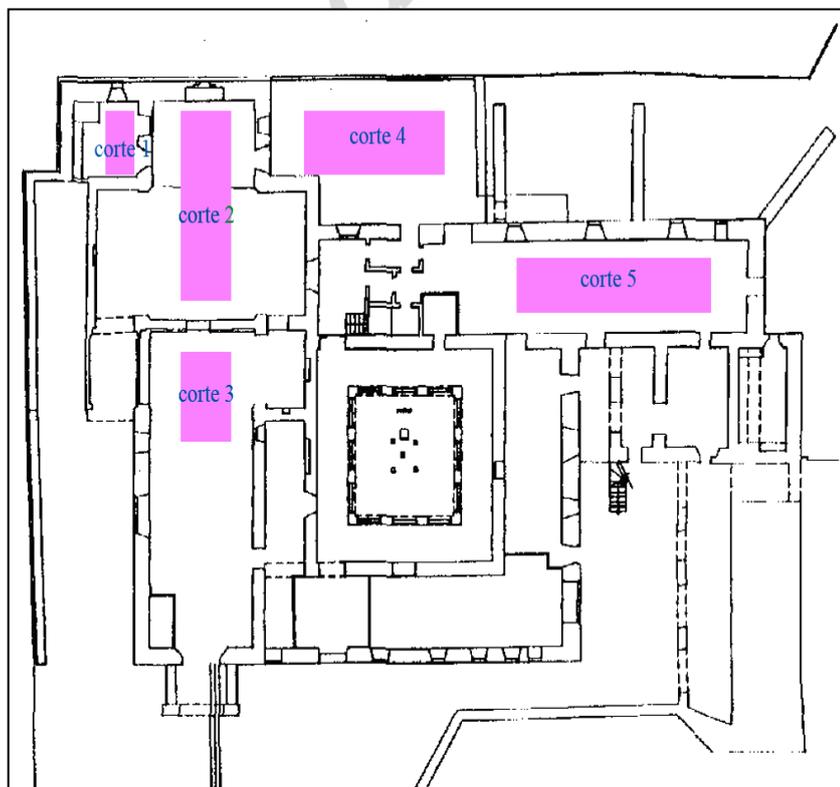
Plano de estructuras existentes con detalle de los cortes realizados.
